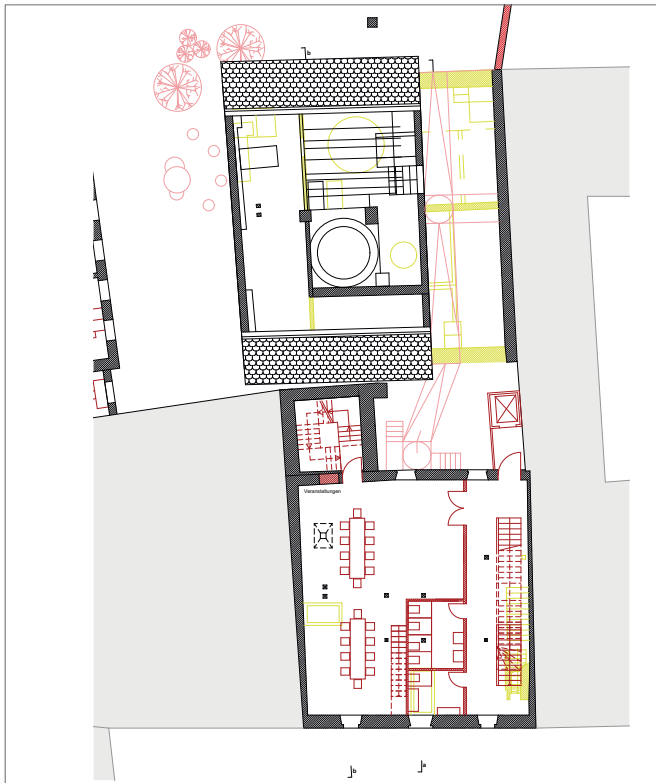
Malz- und Sudhaus, 2. Obergeschoss
